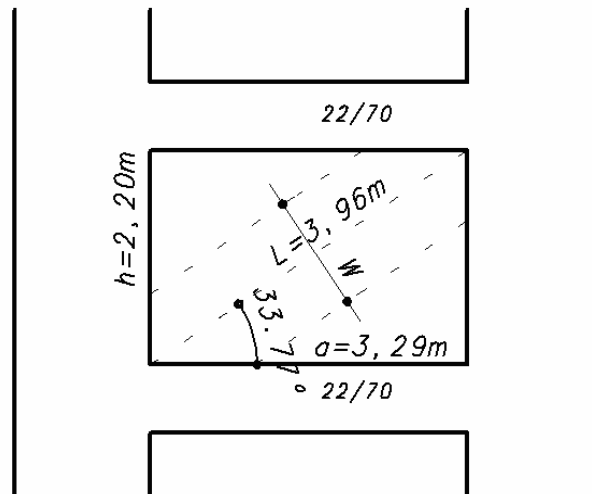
Pórtico 9(segundo proposta de Moreira,2002)
